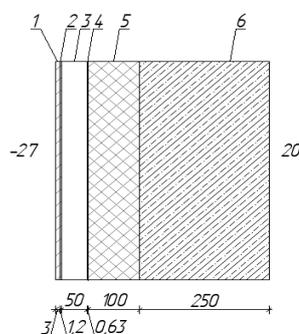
Схема конструкции наружной стены из железобетонных панелей
